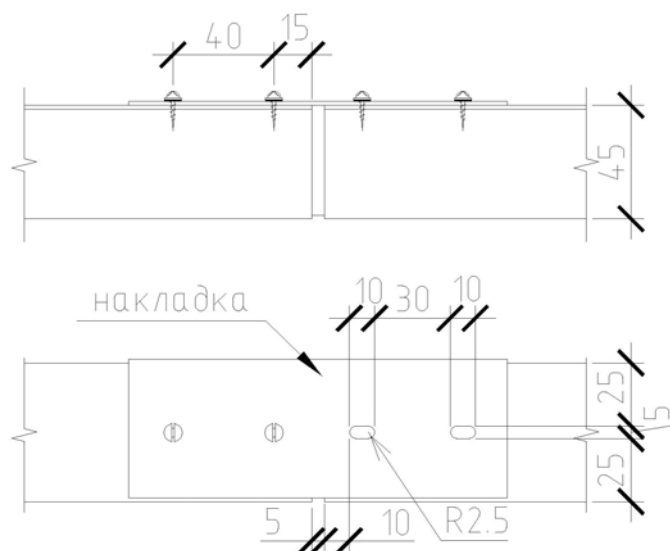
Схема соединения стыкуемого торцами направляющего профиля
